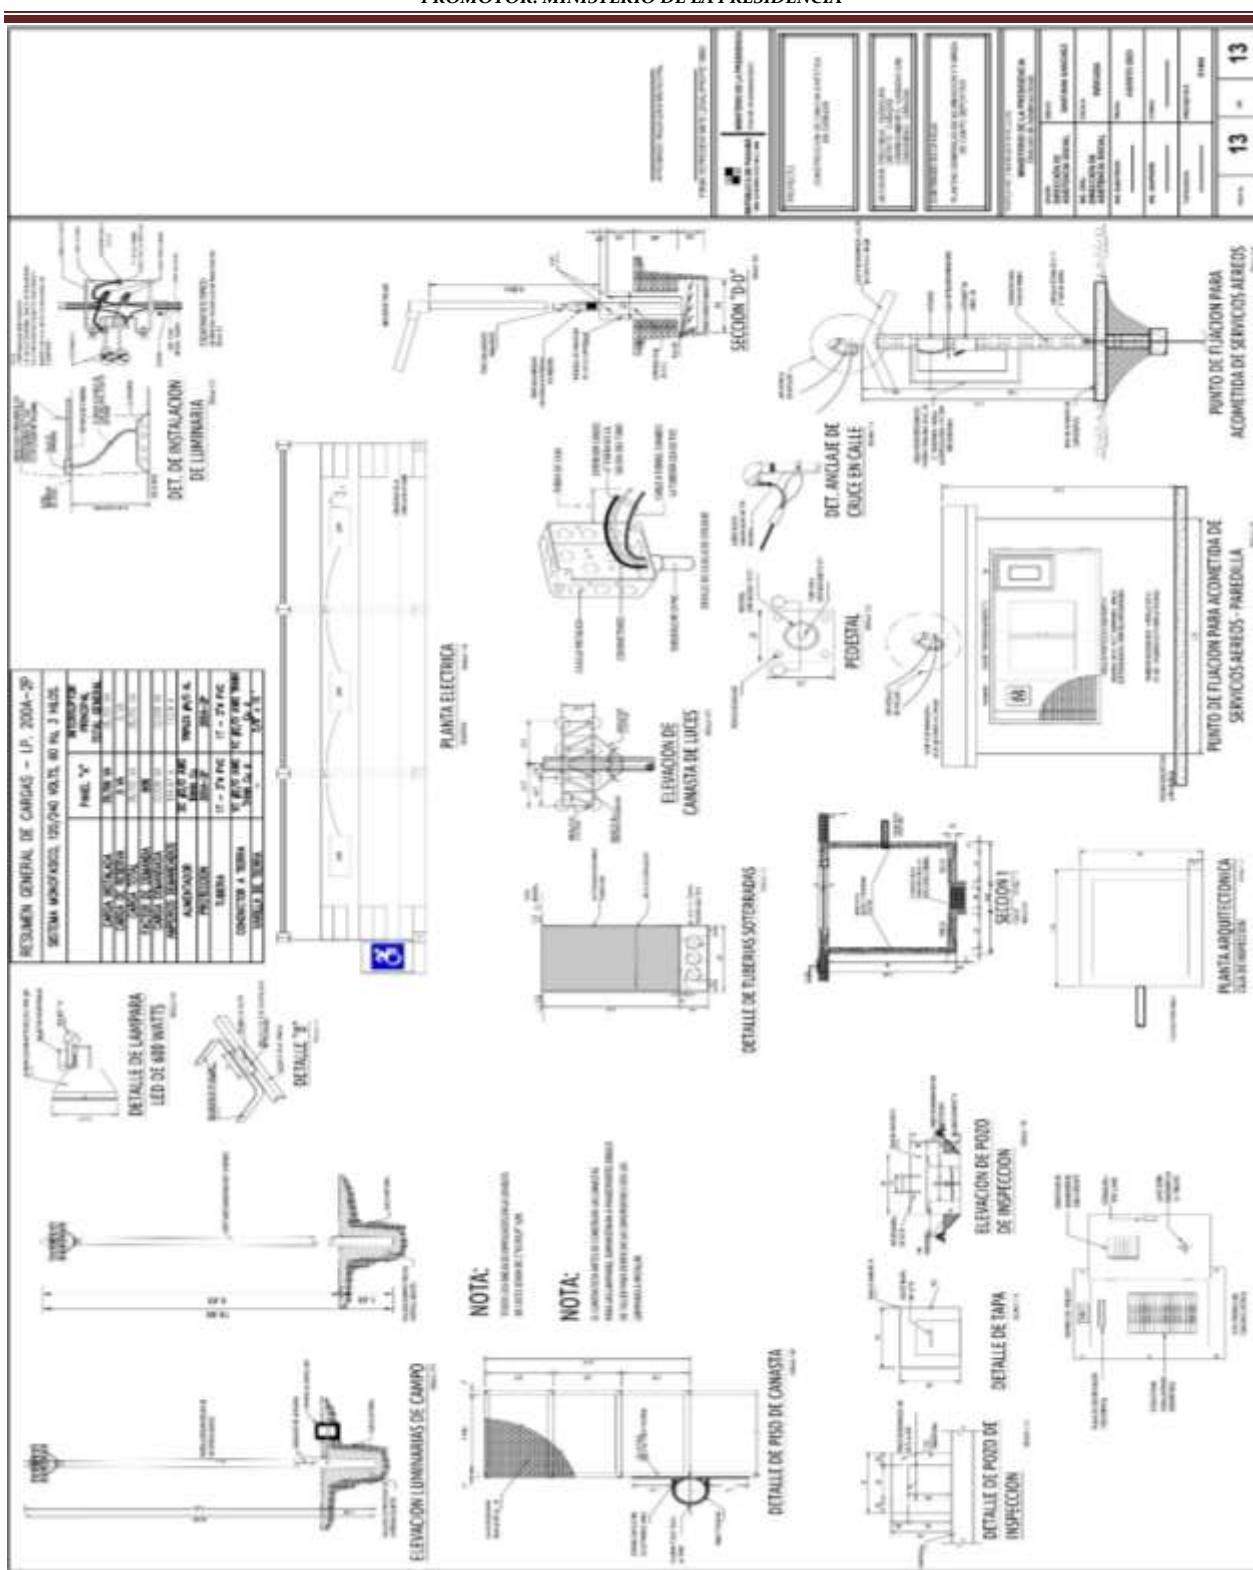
Detalles de la planta general de iluminación y fuerza de campo deportivo.
